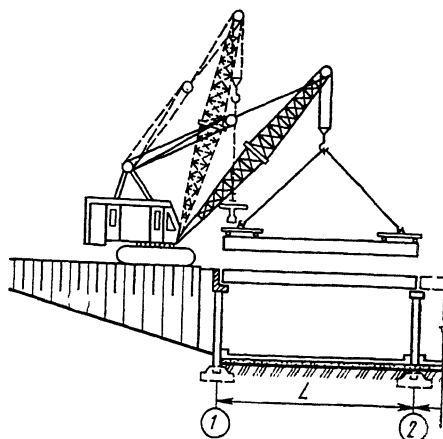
Схема монтажа балок пролетного строения эстакады по способу «вперед себя»
